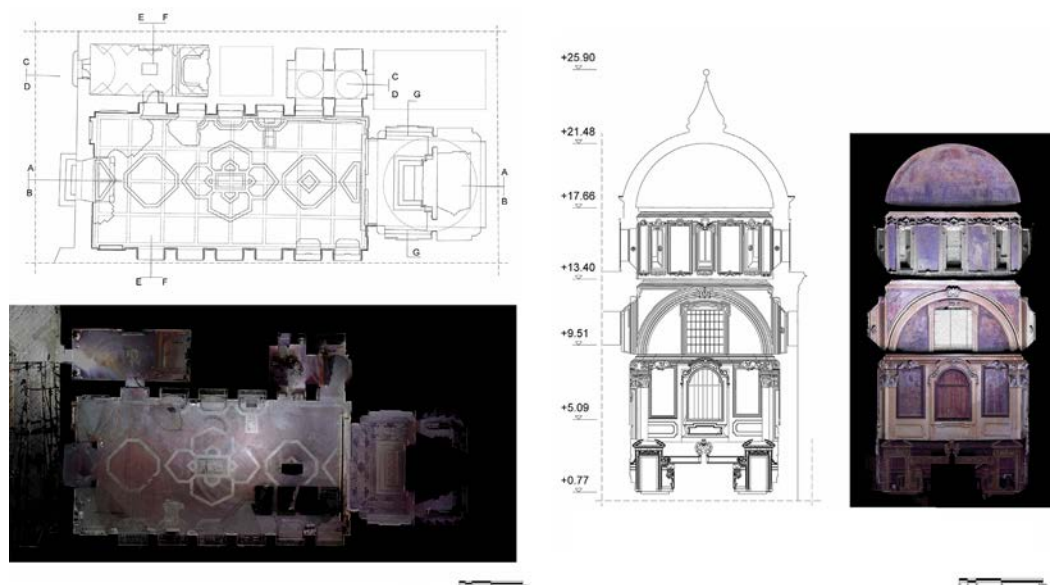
Pianta della chiesa di Santa Maria del Popolo; sezione G-G.
